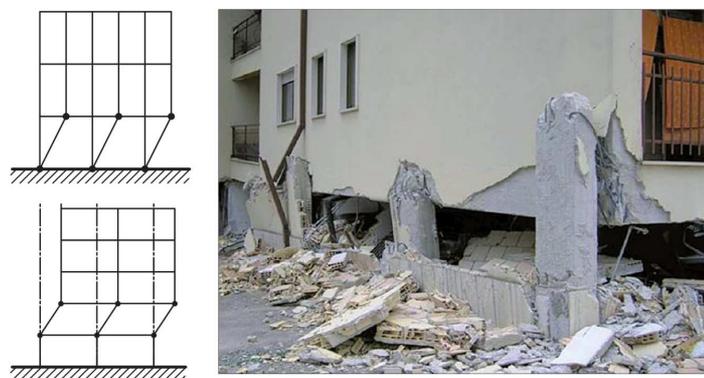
Schematizzazione del meccanismo di piano soffice a piano terra e nei piani intermedi.
